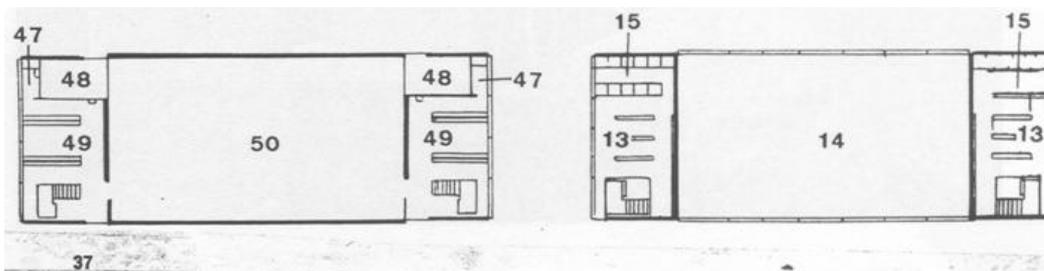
Planta do ginásio: térreo e 1º pavimento.
